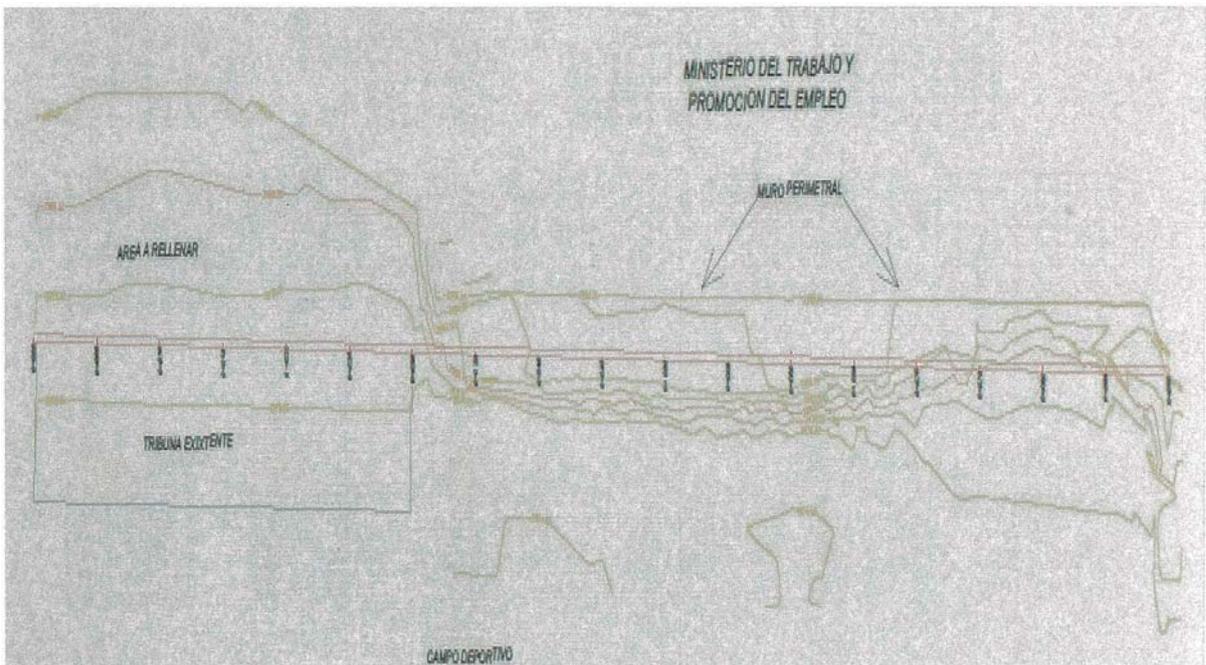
Vista en Planta de Muro Anclado Proyectado según Levantamiento Topográfico
